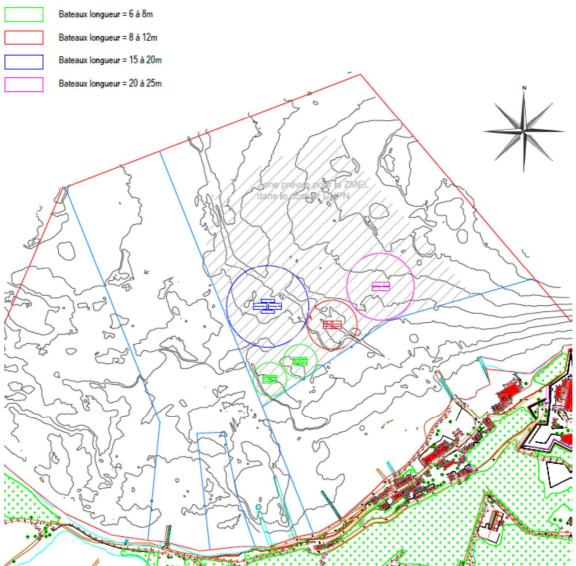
Plan masse du scénario 2 : amarrage sur ponton
